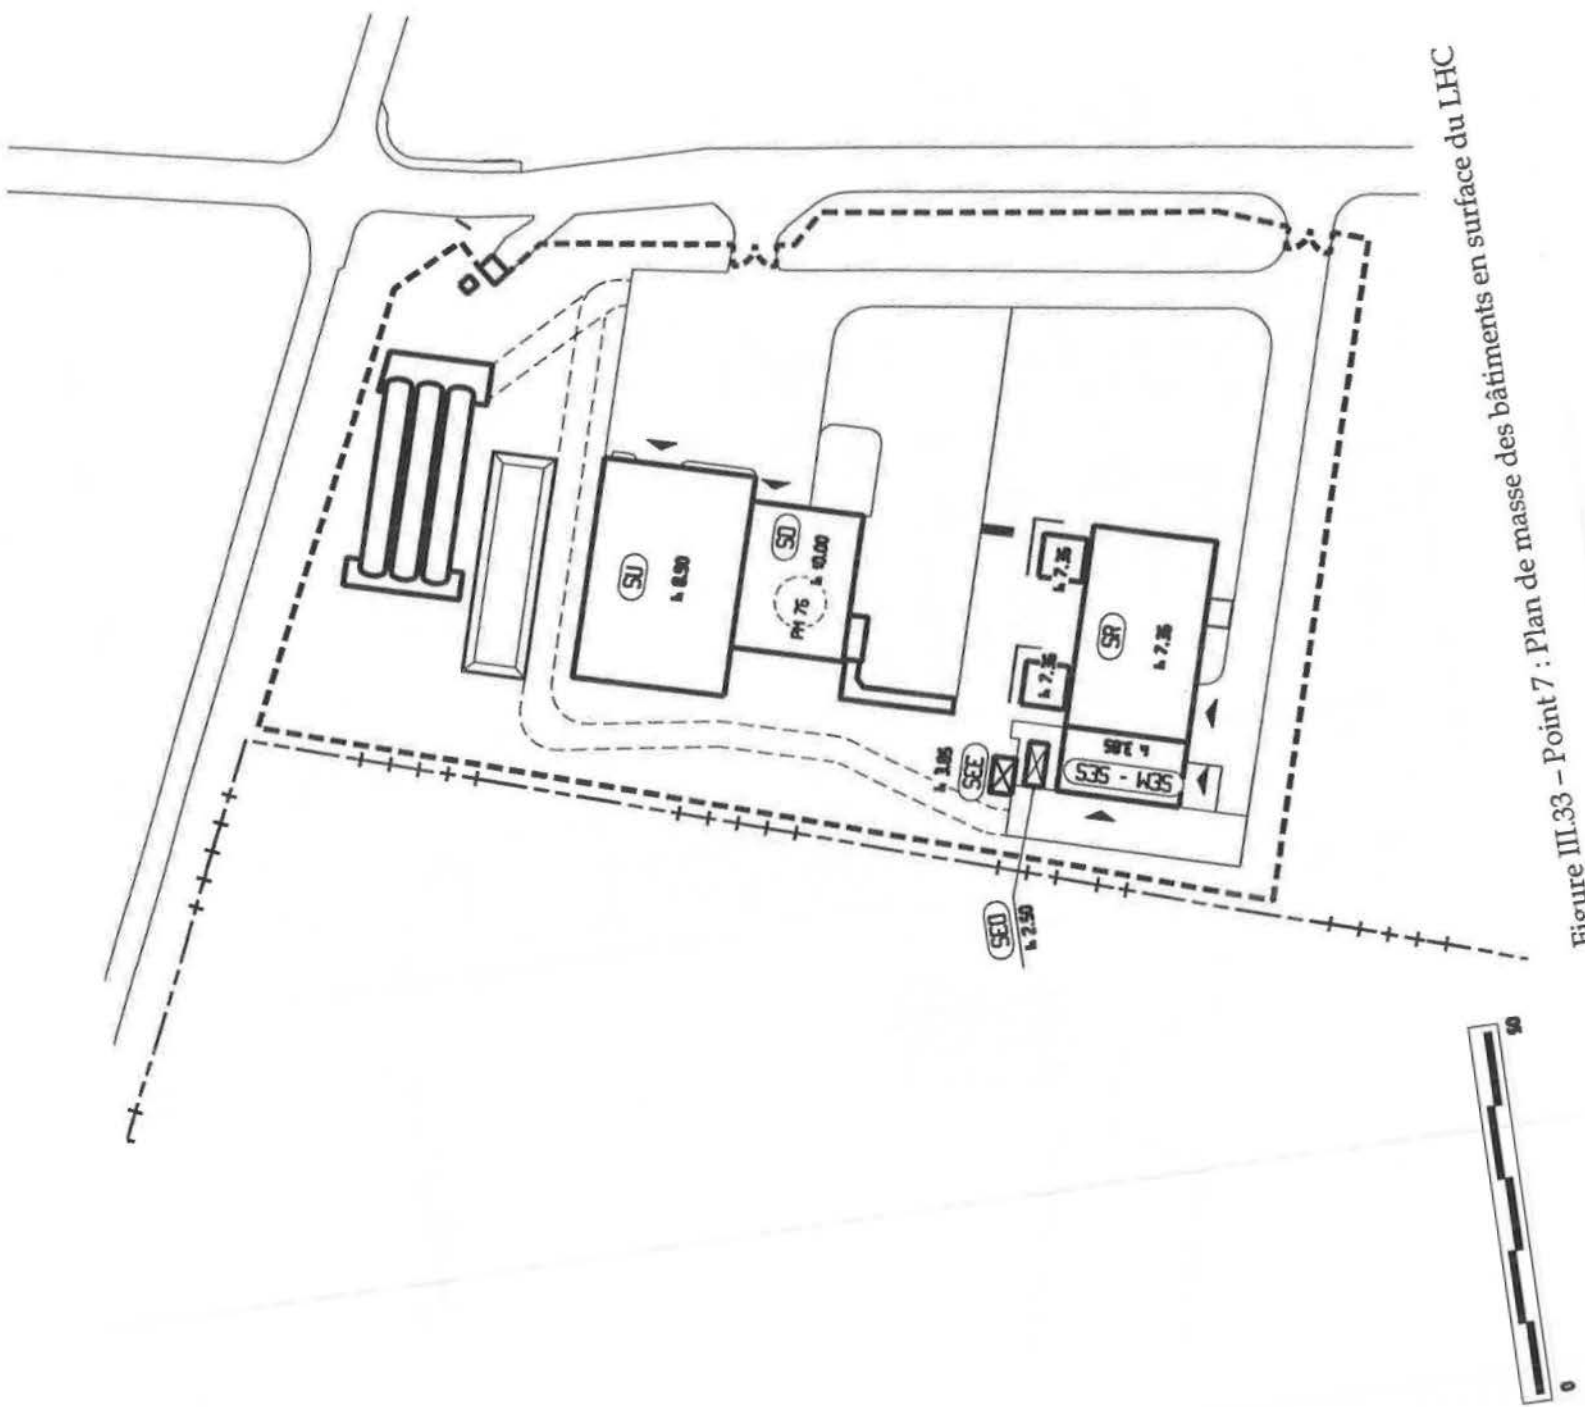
Point 7 : Plan de masse des bâtiments en surface du LHC
